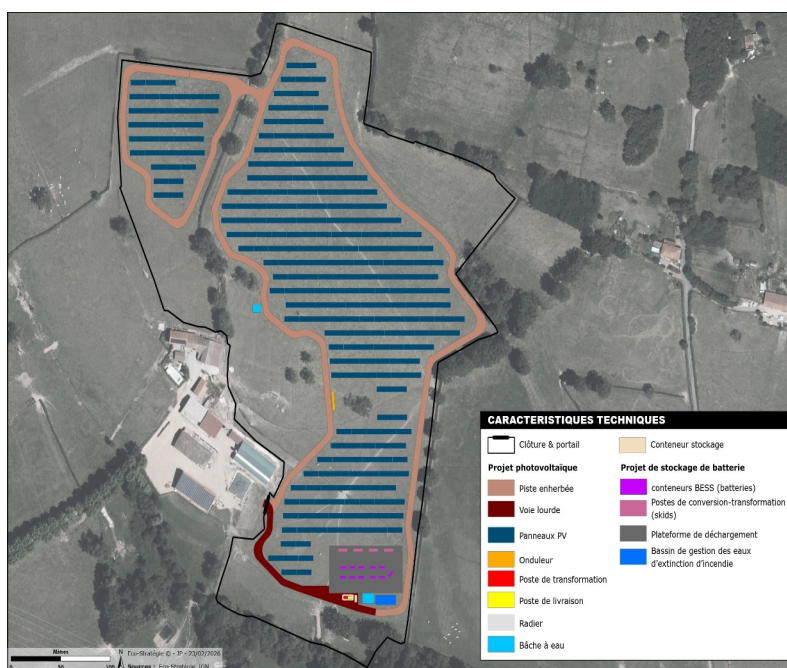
Plan d'implantation du projet d'environ 12 ha (source :dossier)
